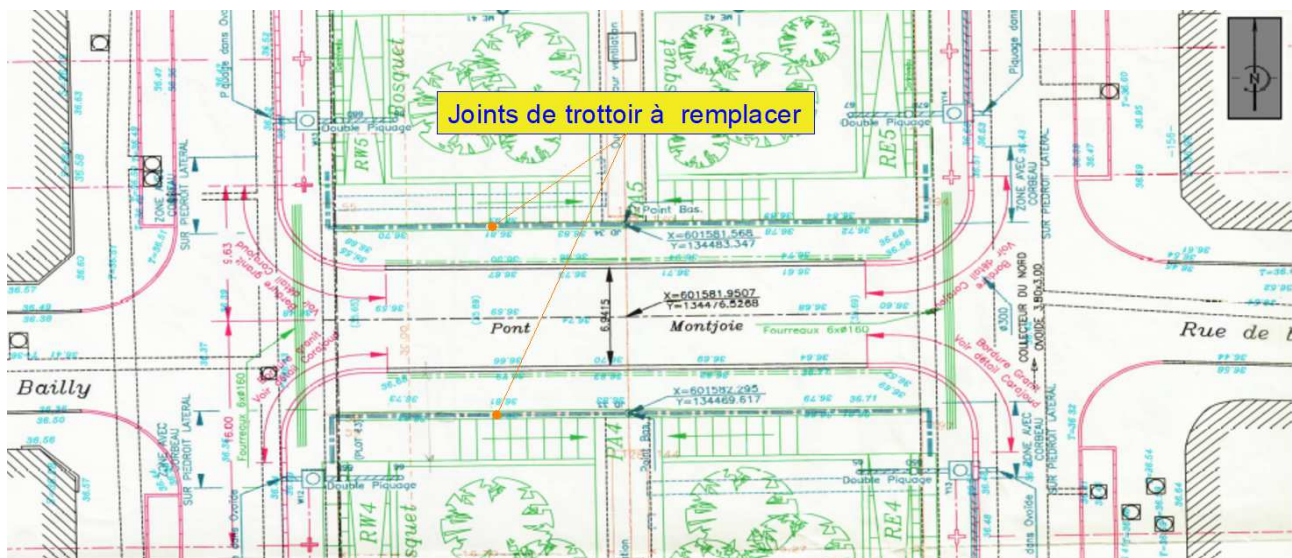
Extrait de la vue en plan des joints de chaussée du Pont Montjoie
